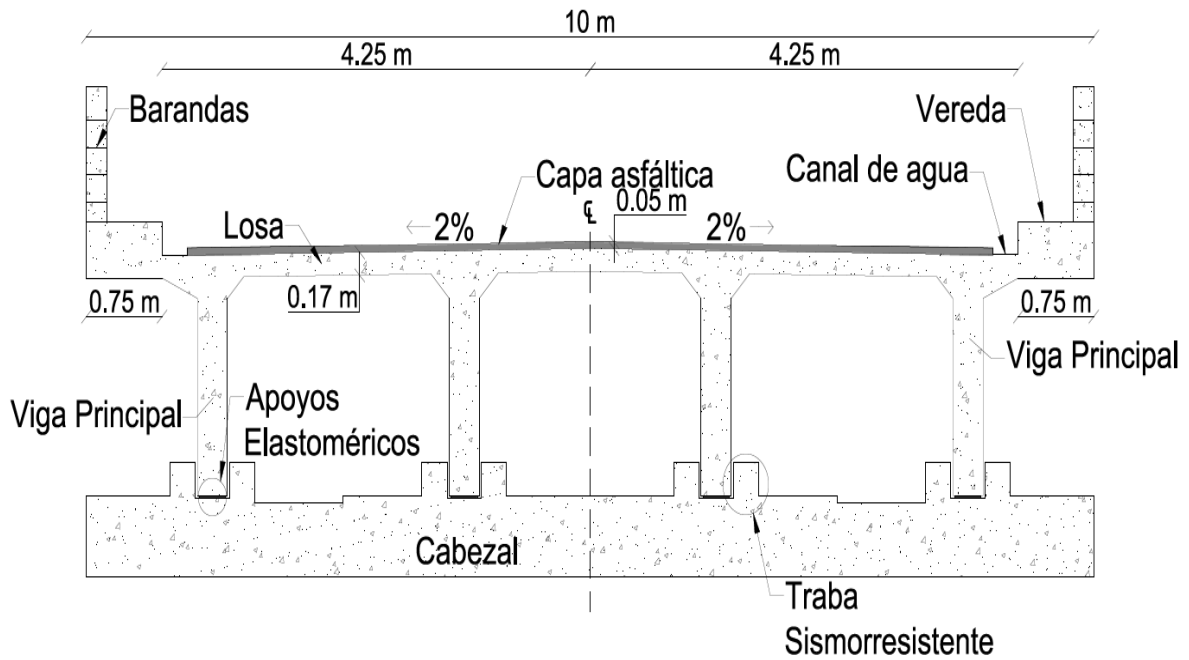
Vista en elevación lateral izquierda del puente
